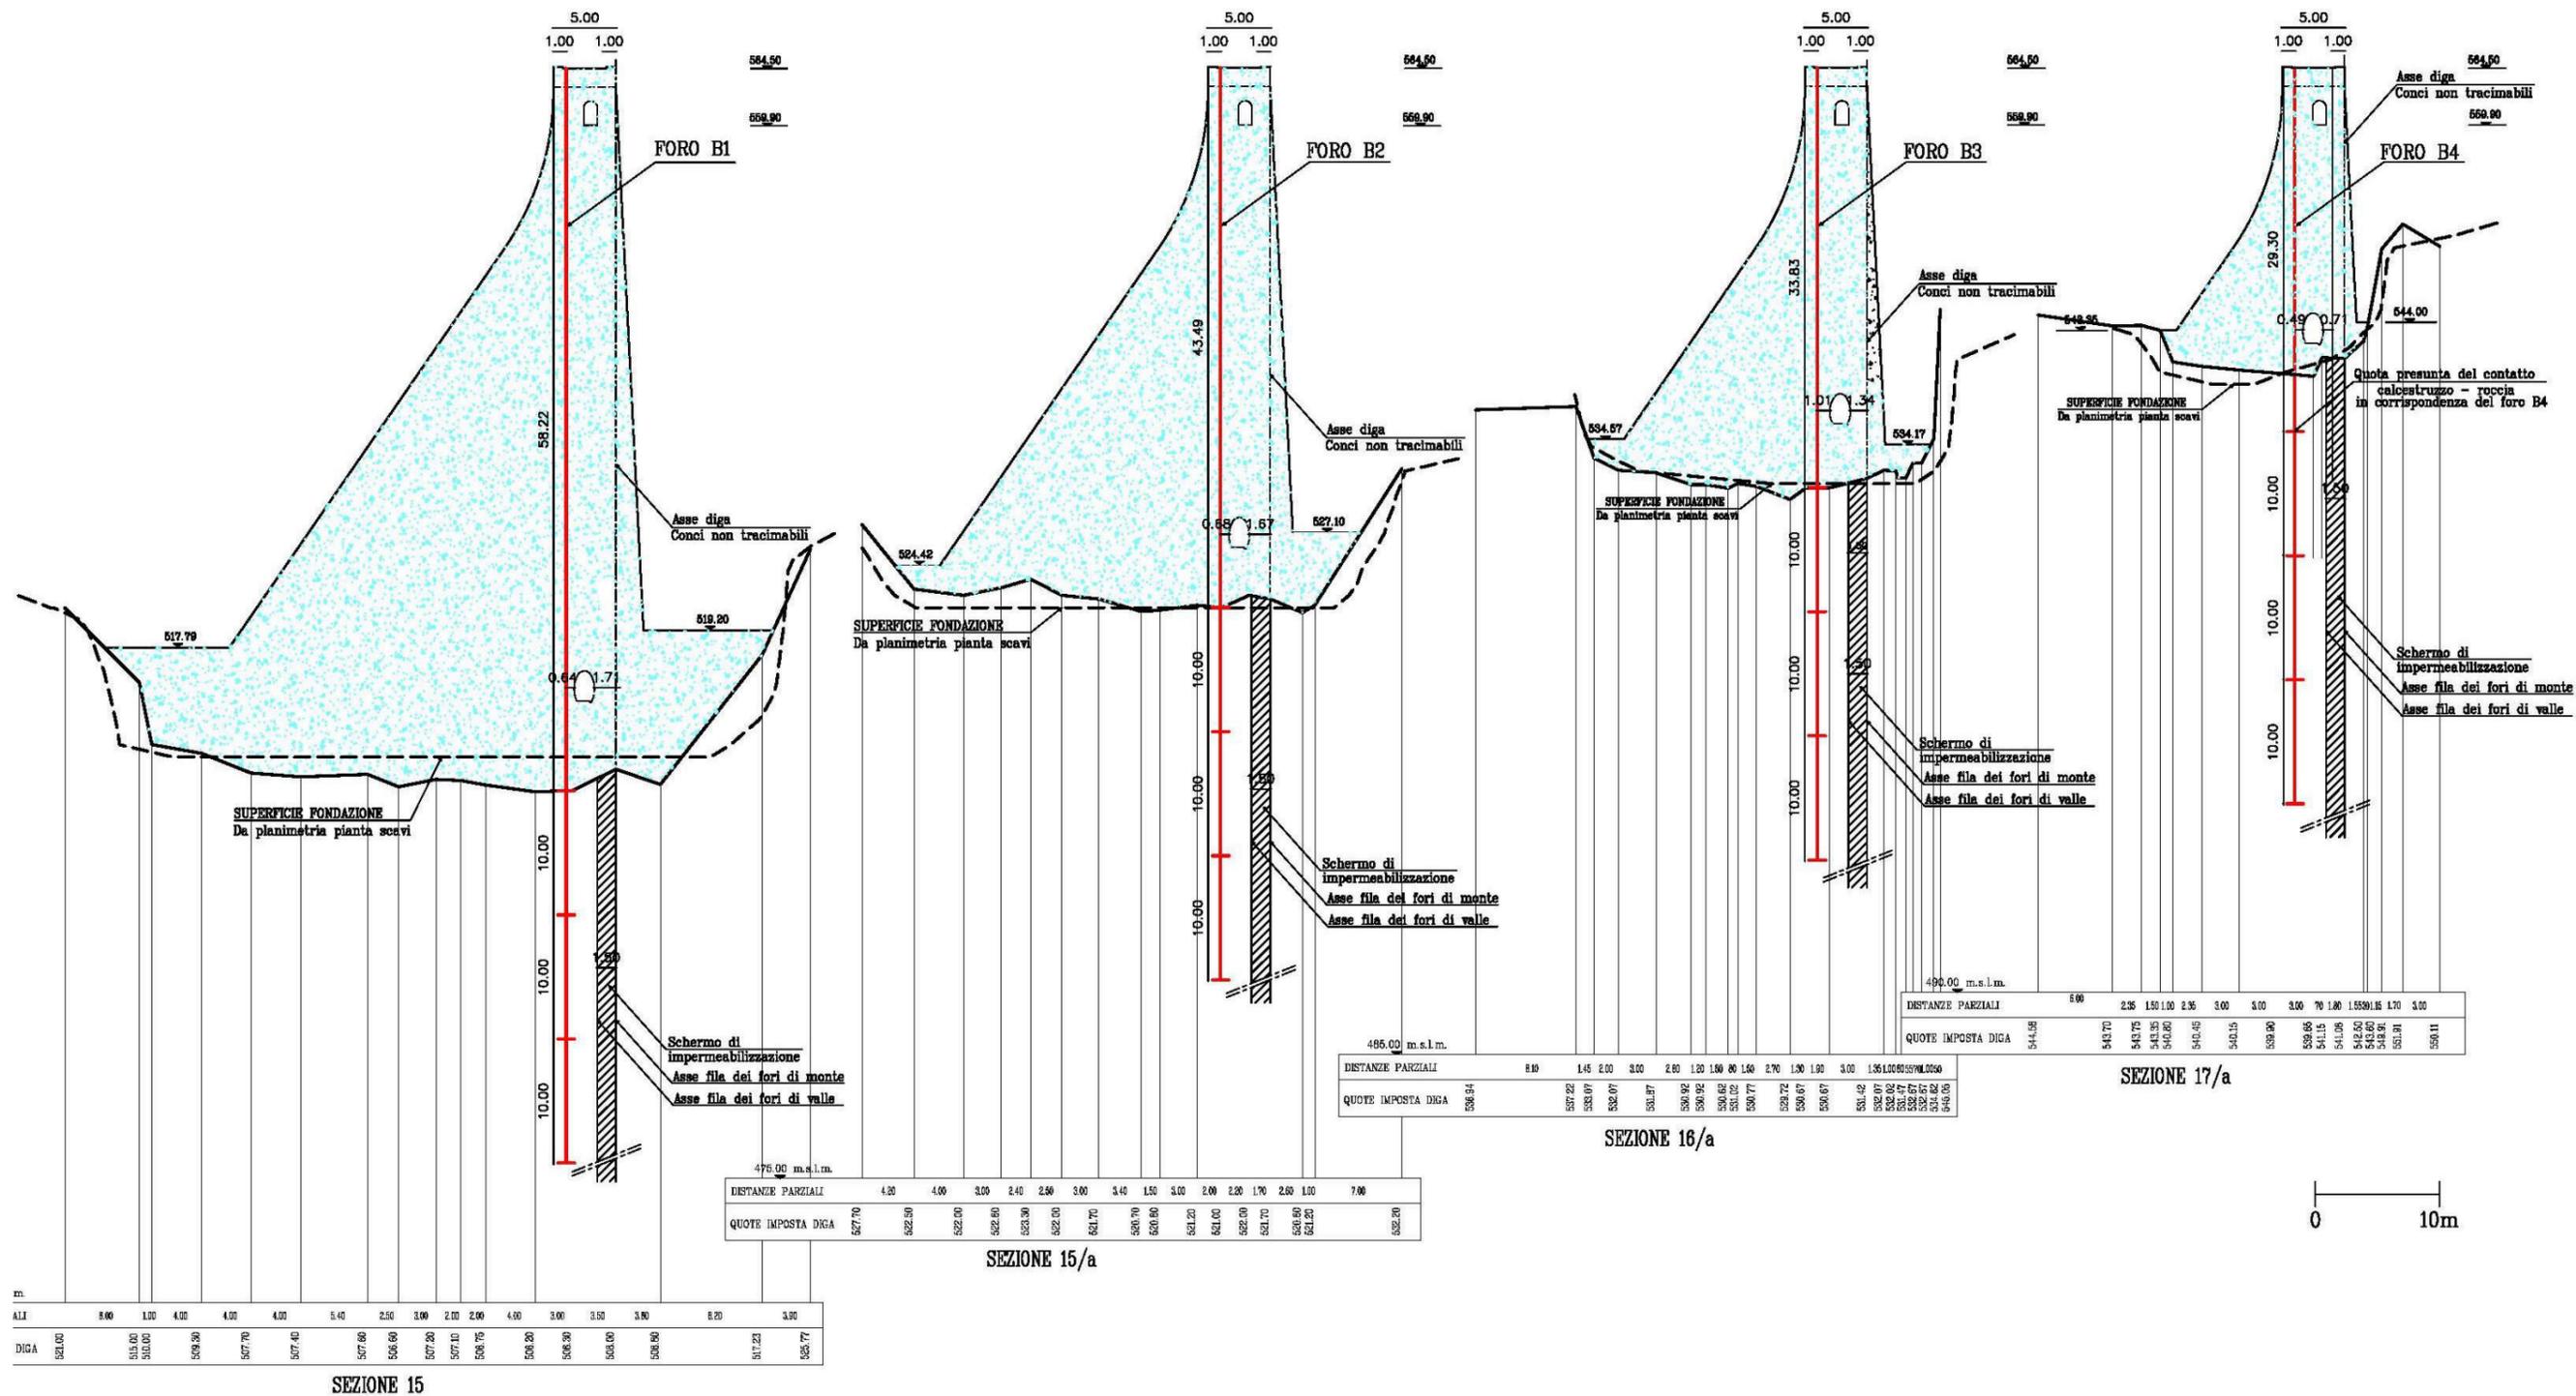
Sezioni tipo (monte-valle); soluzione proposta per l'esecuzione dei sondaggi dal coronamento diga.
